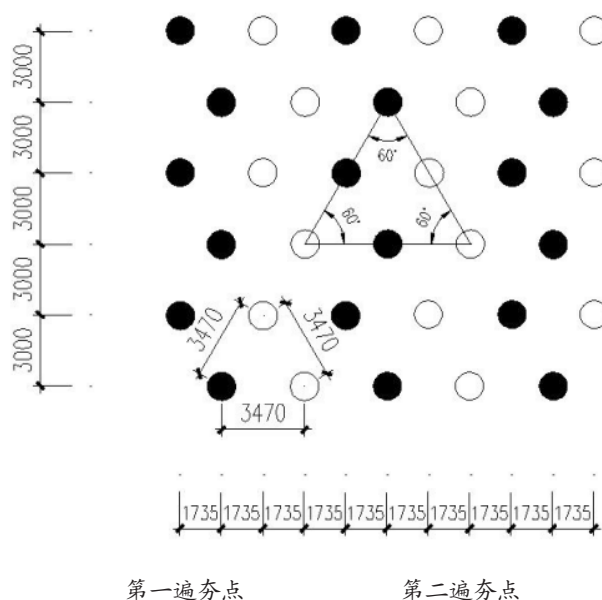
第一遍点和第二遍点夯夯点平面布置 (单位: mm)
